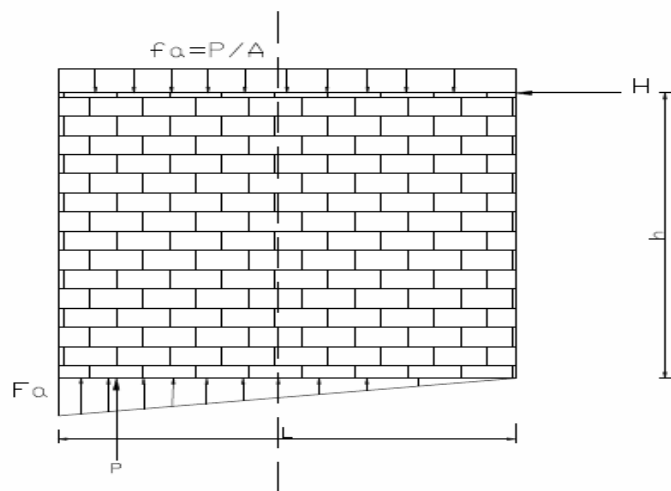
Equilibrio de la mampostería no reforzada en el instante de tracción nula. Fuente: (Gómez, Rodríguez, et al. 2006).
